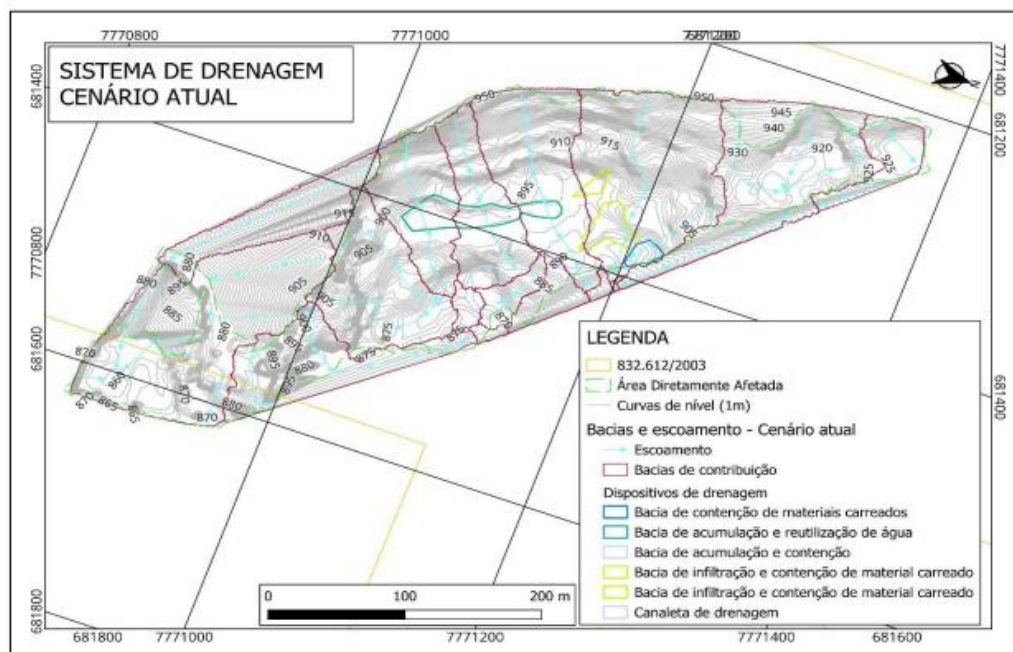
Planta de sistema drenagem. Fonte: Autos do processo SLA nº591/2023.
